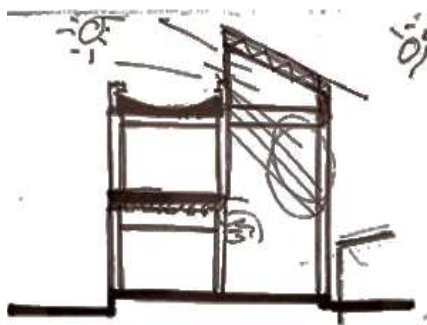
Corte esquemático de zonificación. Elaboración propia
